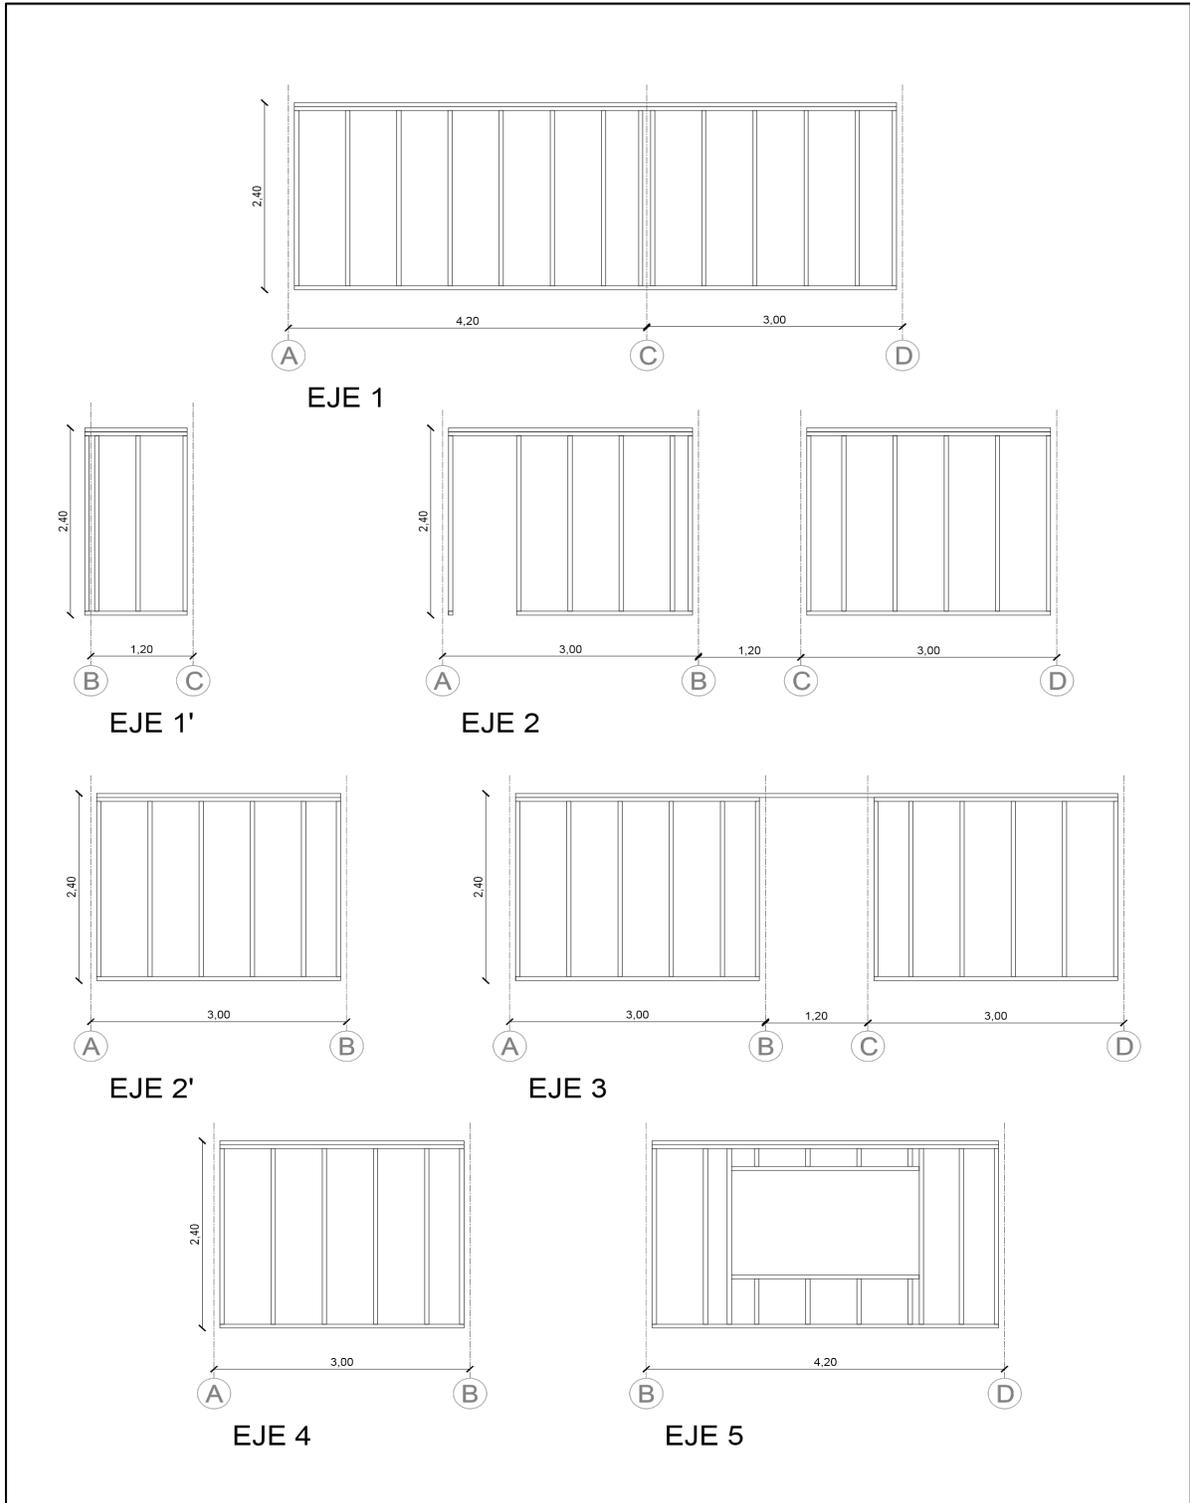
Elevaciones de estructuras modelo entramado de madera 2x6"
